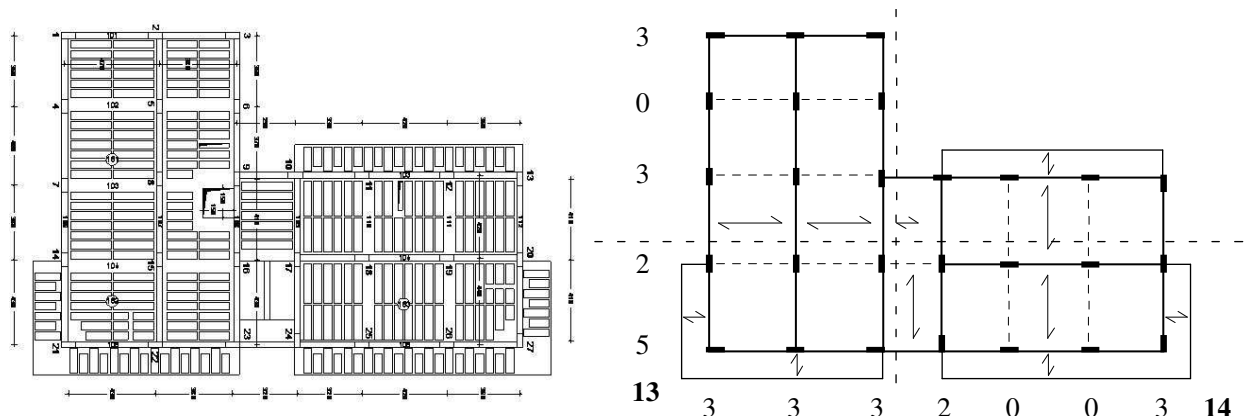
Distribuzione dei pilastri nella carpenteria tipo
